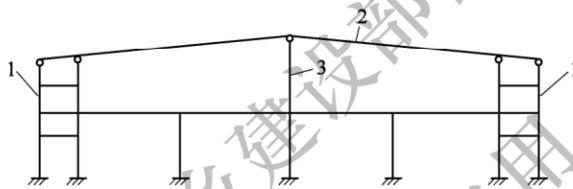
下层钢筋混凝土框架结构、顶层屋面钢结构厂房
